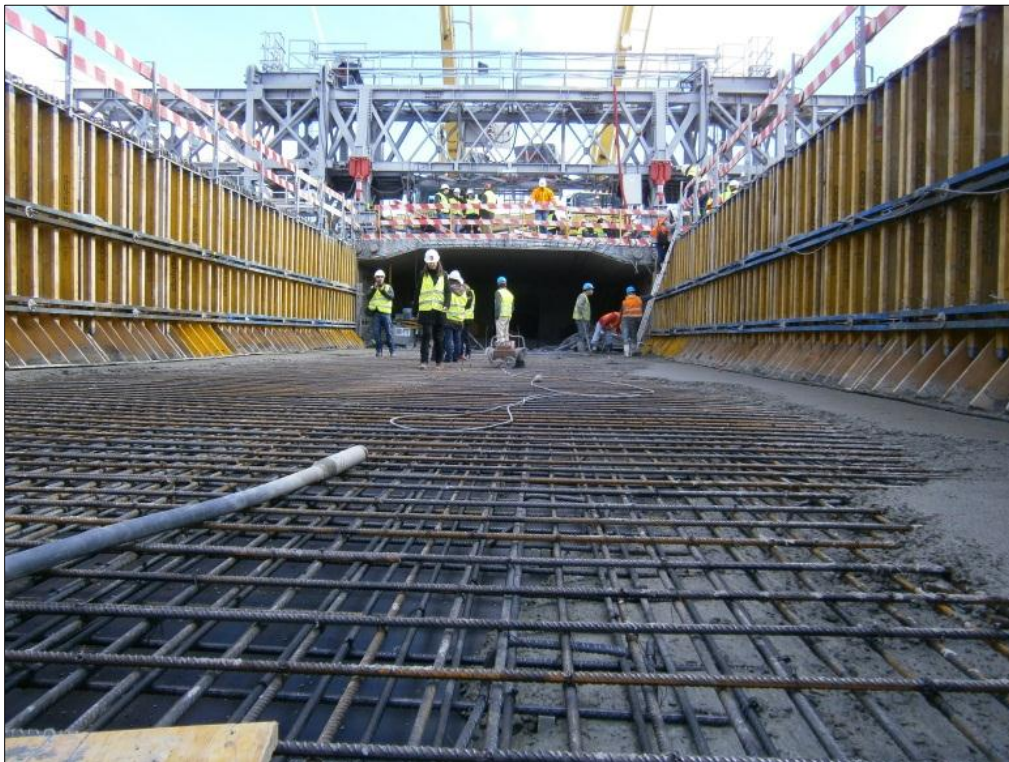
Tabuleiro pronto para a fase de betonagem, suportado pelo M60-I.
